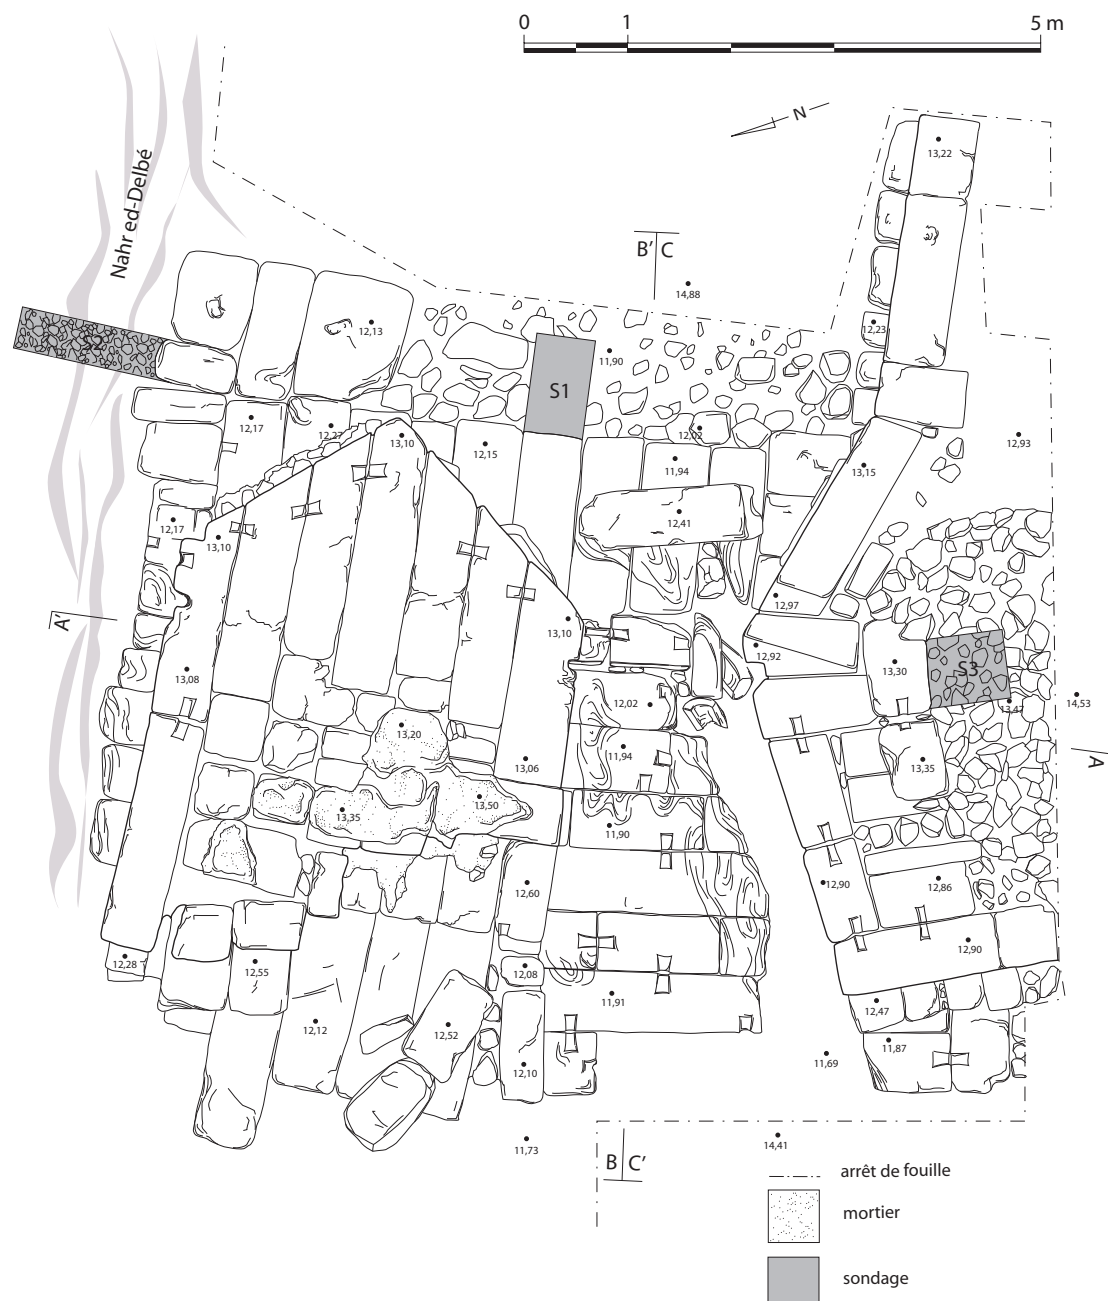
Plan du pont-barrage au sud de Ras Shamra (état de la fouille en 2009)
